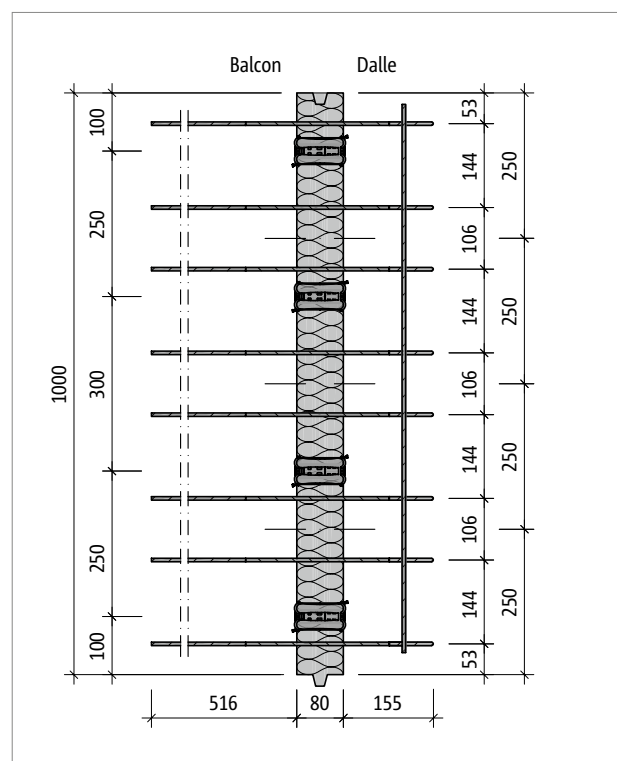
Schöck Isokorb® T type Q-E-W-V3 : plan de base du produit
